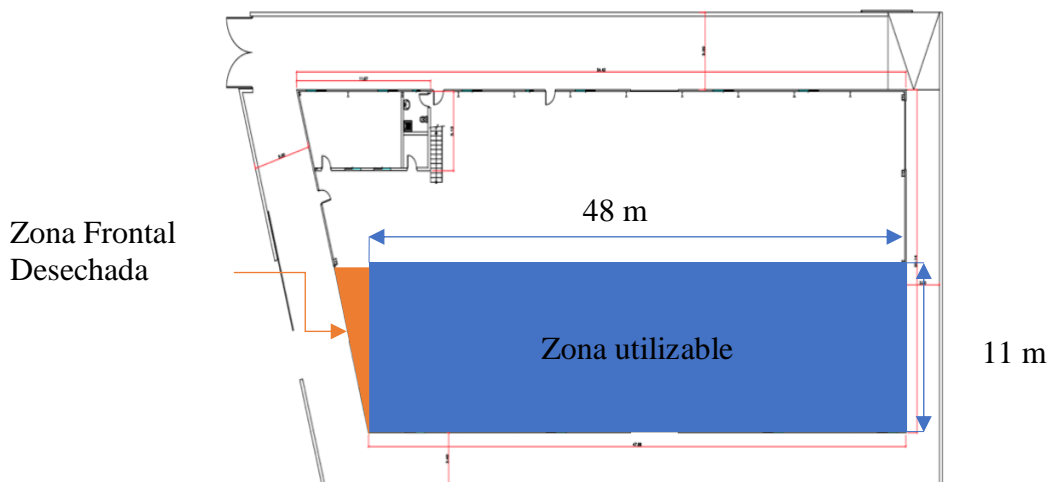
Alzado de la planta con descripción de la zona donde ubicar los paneles.
